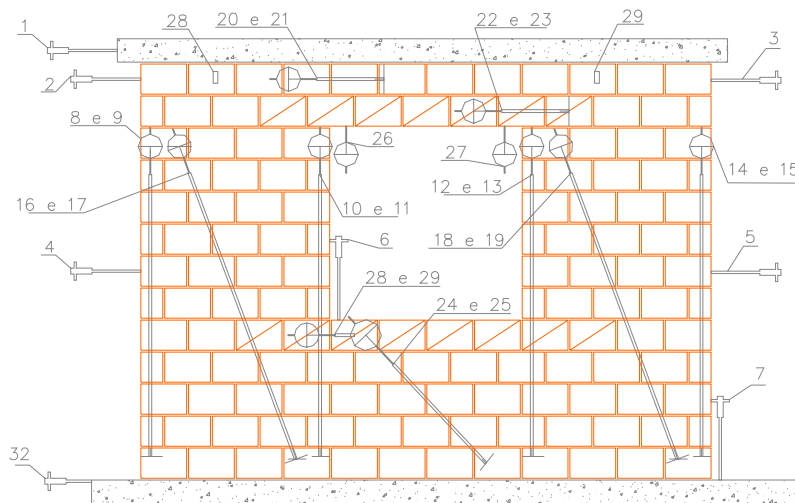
Disposição da instrumentação dos painéis da 4ª e 5ª configurações de ensaio.
